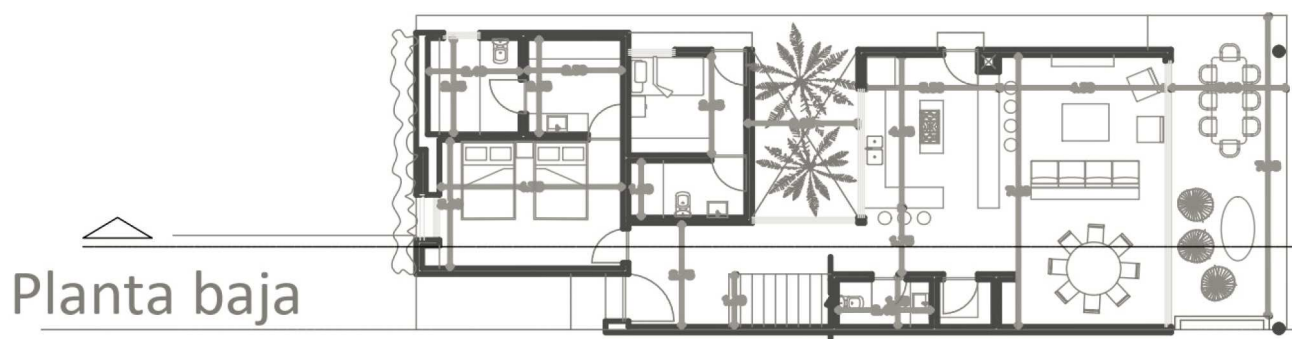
Plano distribución de las unidades habitacionales en planta baja
